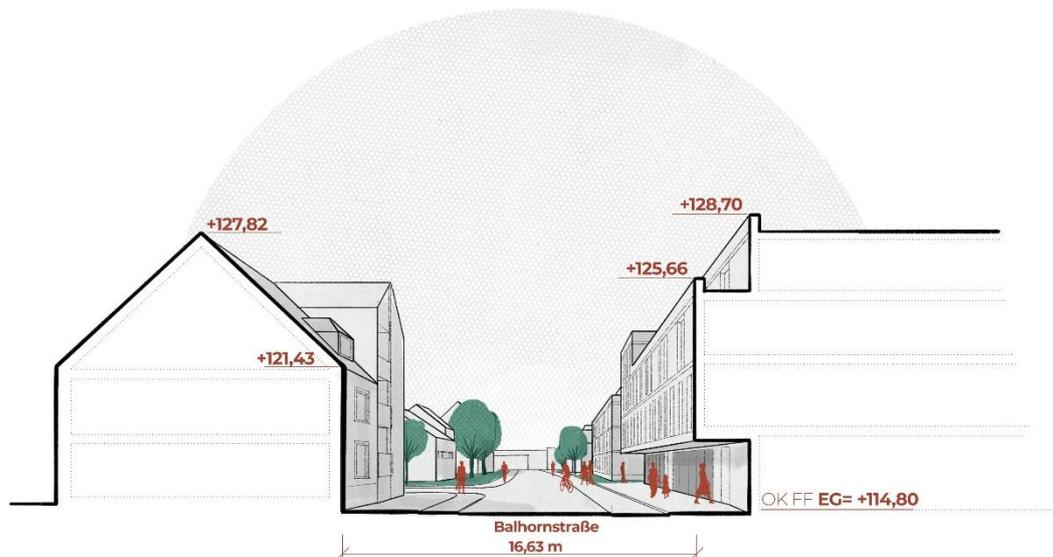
Straßenschnitt Balhornstraße, Postquartier Paderborn, 17.11.2023, behet bondzio lin Architekten
